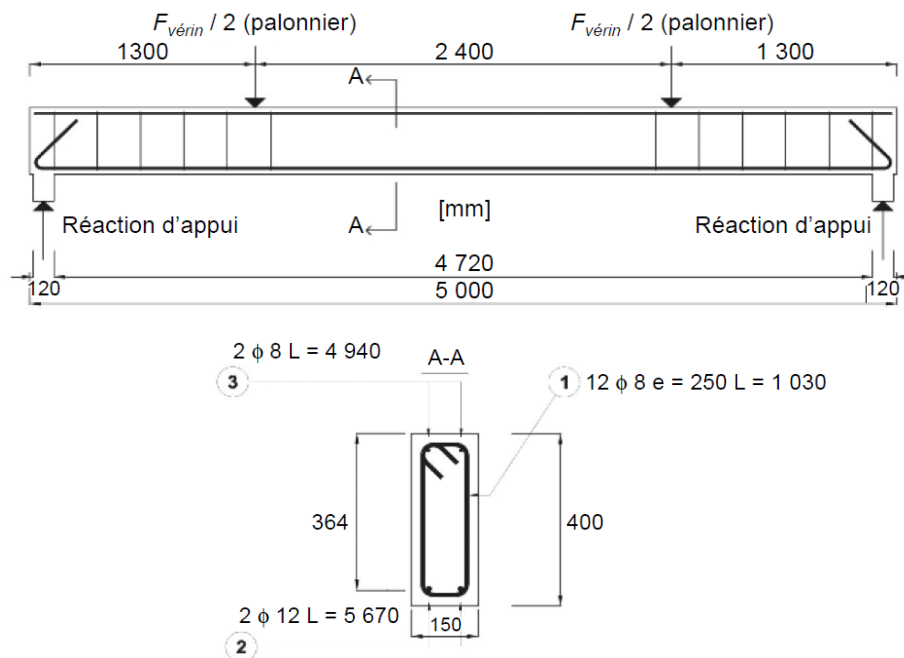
Essai de flexion à quatre points et plan de ferrailage [42].
